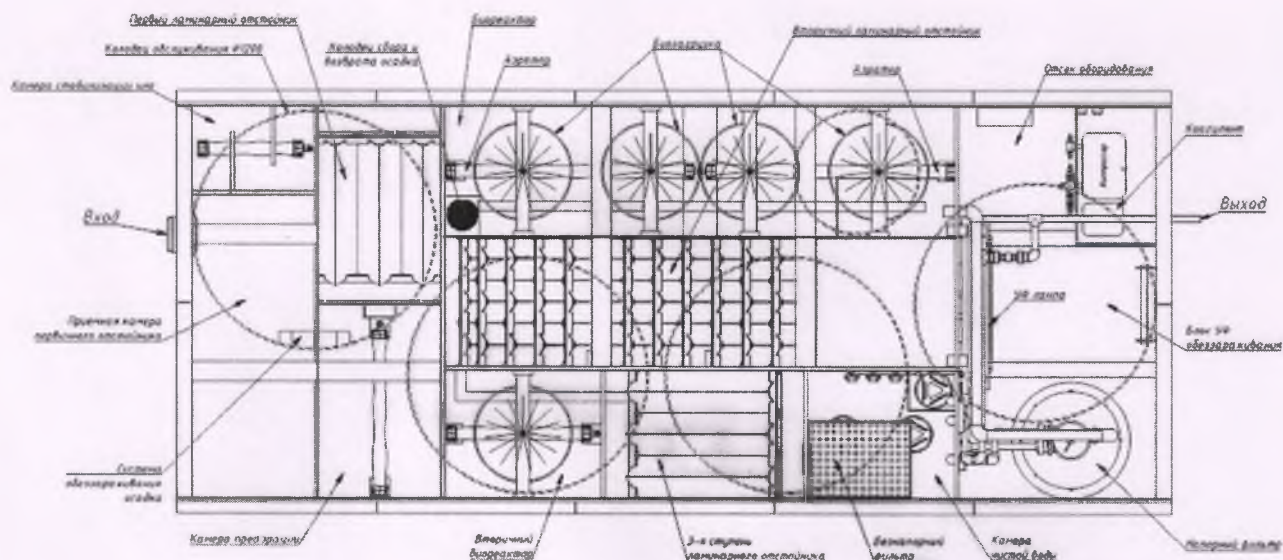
Схема размещения оборудования внутри корпуса станции очистки
